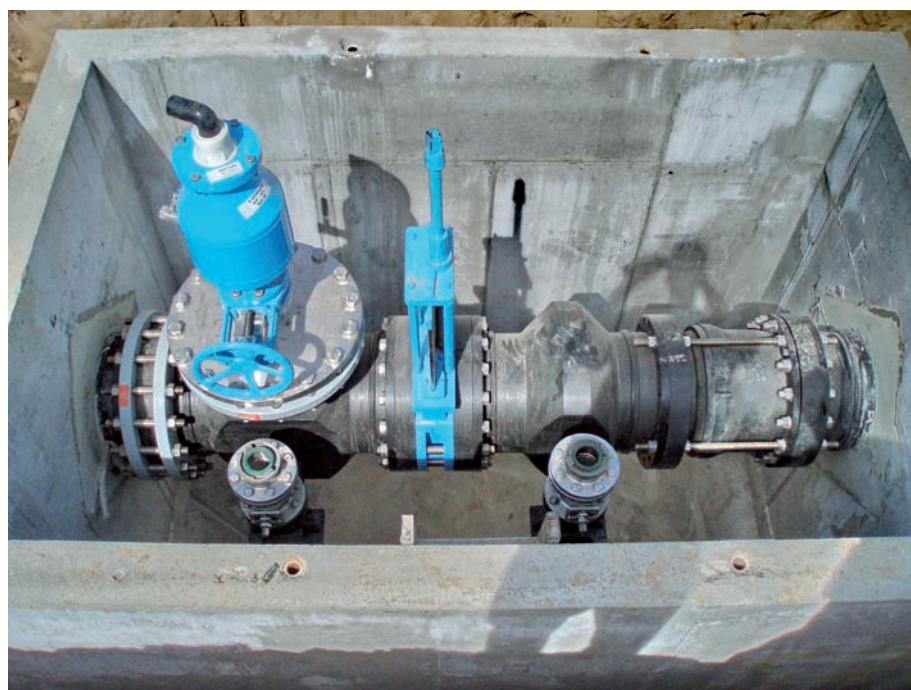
Maßgeschneiderte PE 100-Baugruppe im Schacht
